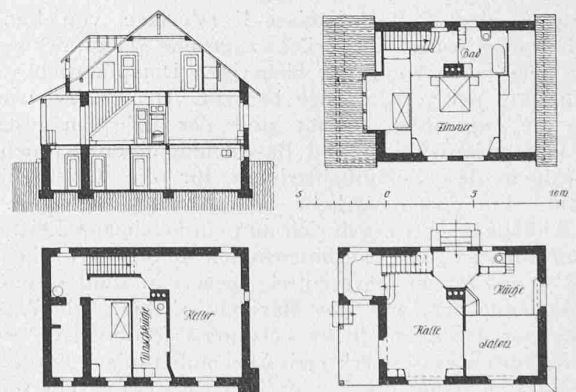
Landhaus Debeuf. — Grundrisse und Schnitt 1 : 400.
